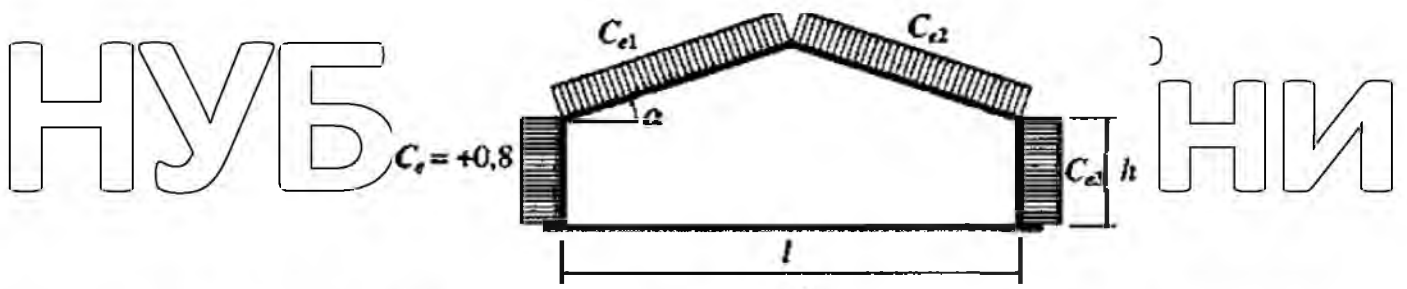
Розрахункова схема будівлі на дію вітрового навантаження
